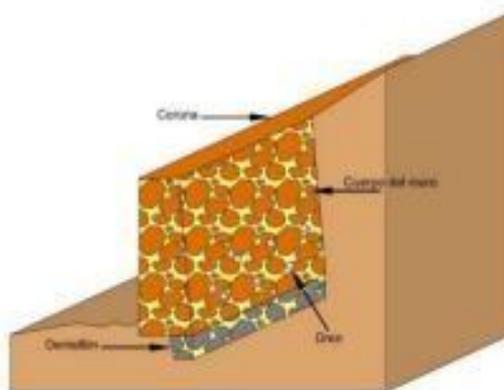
Muro de mampostería de piedra braza con drenes y dentellón, para sitios con riesgo de deslizamiento
